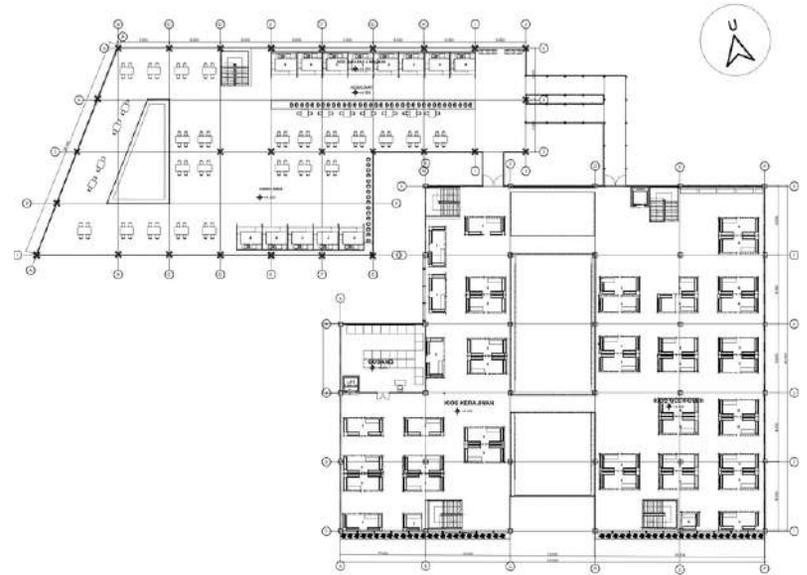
Skematik Denah Foodcourt Lt 2
